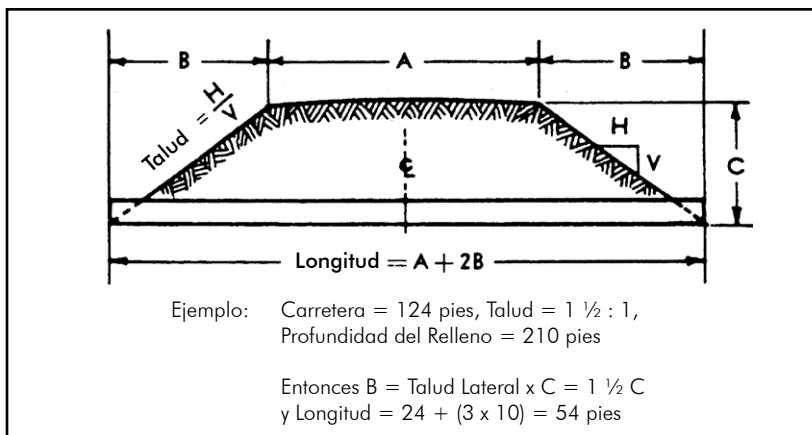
Cálculo de la longitud de la alcantarilla - línea de flujo en nivel plano.
